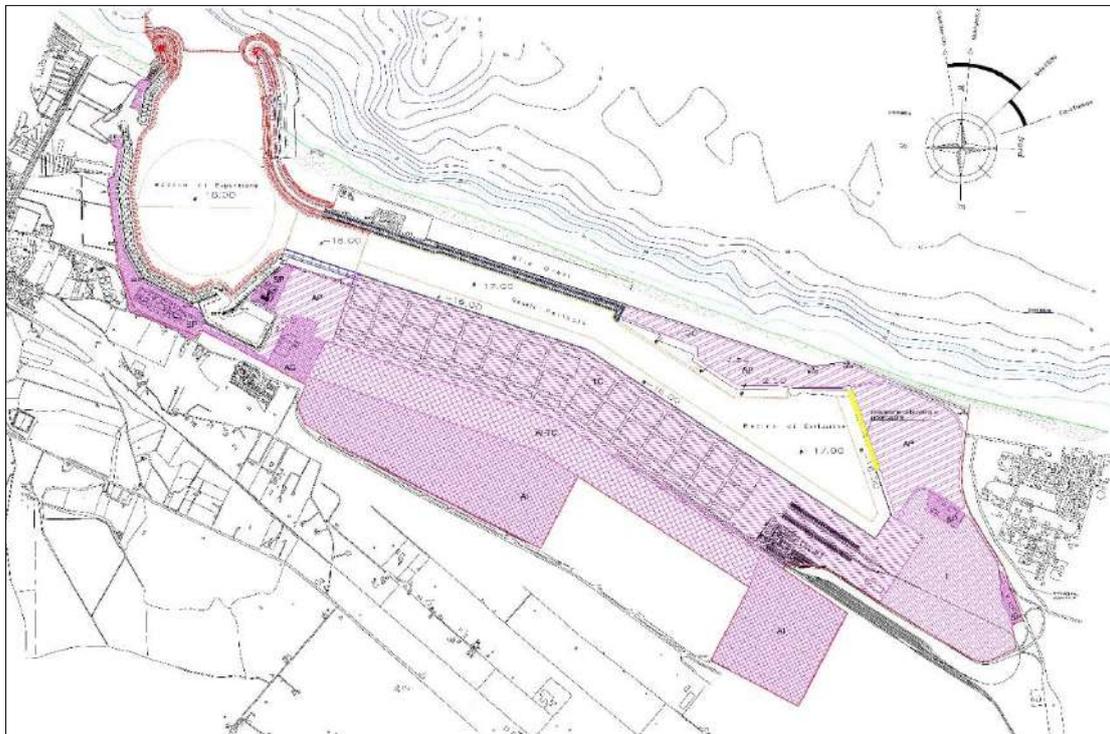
Stralcio ATF 2005 – Planimetria piano pescaggi
